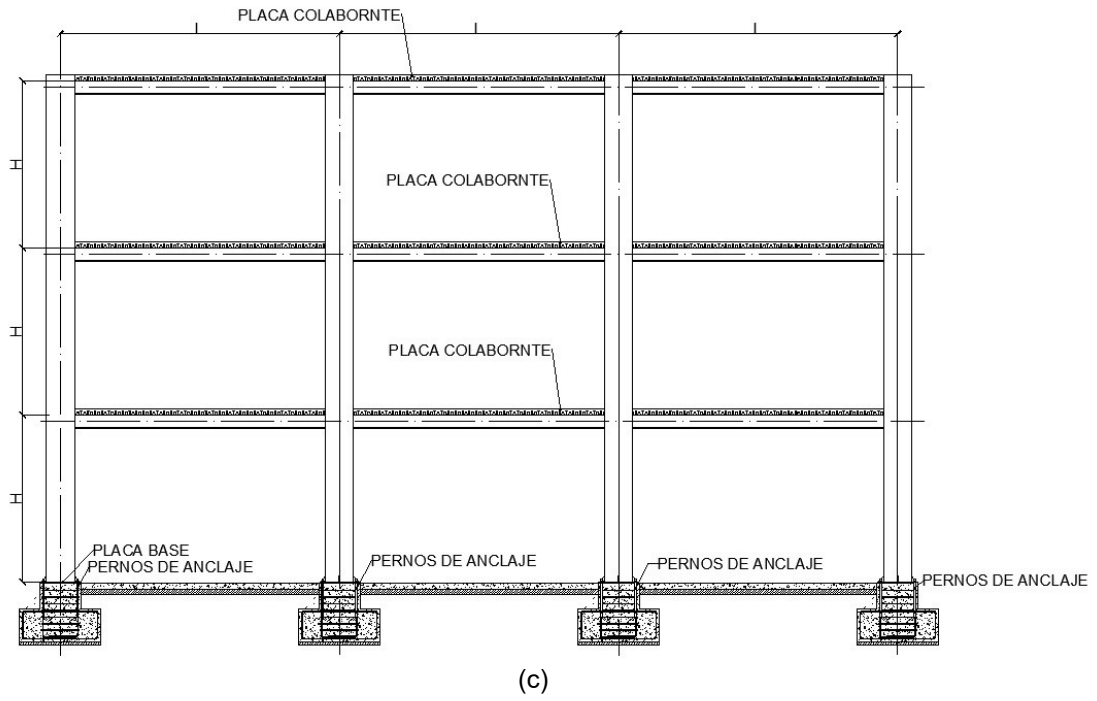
2- Geometría en planta y elevación de edificios de OMF y SMF
